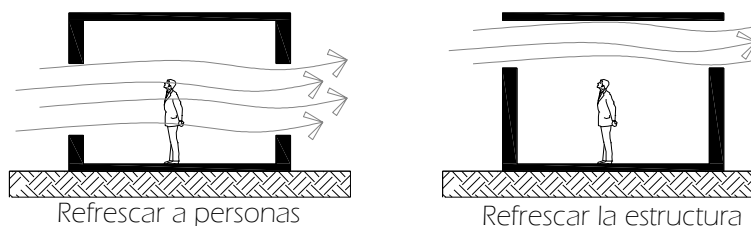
Ubicación de ventanas en alzado. (Fuente propia).
